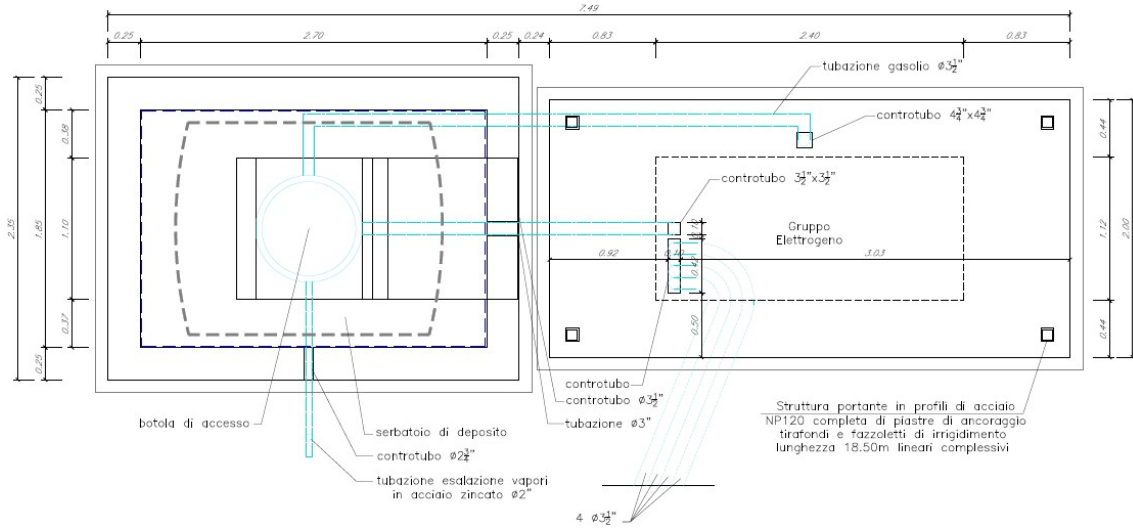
Vasca di serbatoio di GA1 PP/ACC Boschetto – Pianta
